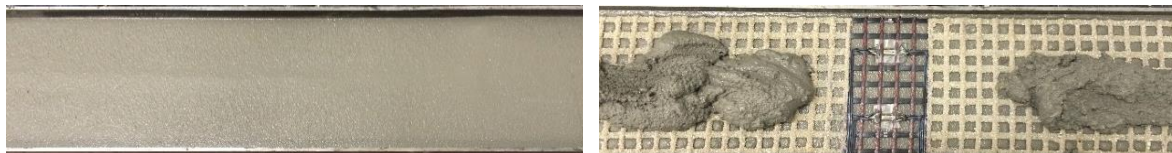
Processo de moldagem das placas para o ensaio de flexão
